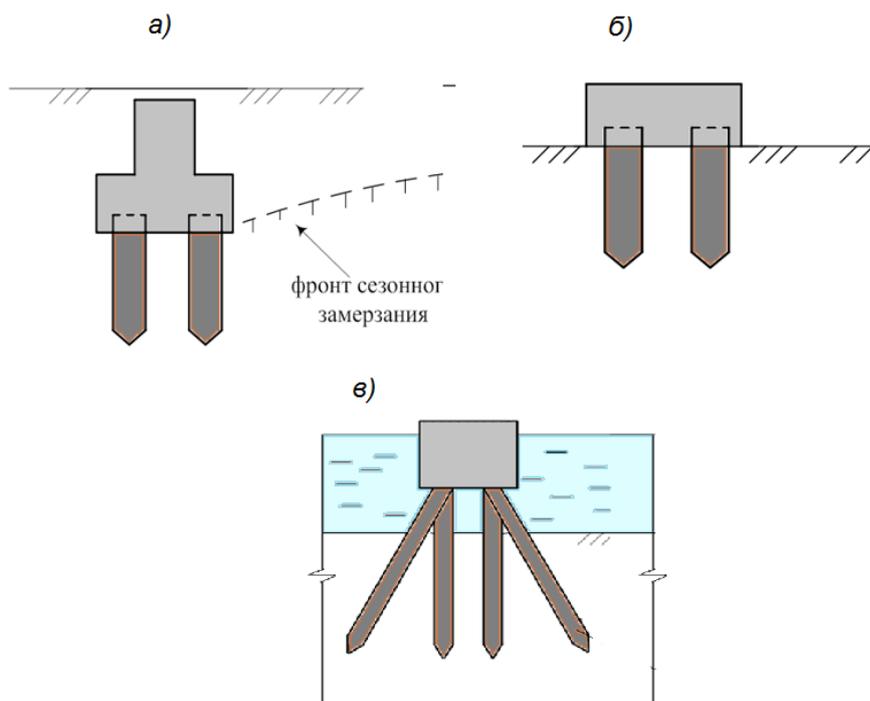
Типы свайных ростверков: а)- низкий; б) – повышенный; в) – высокий
